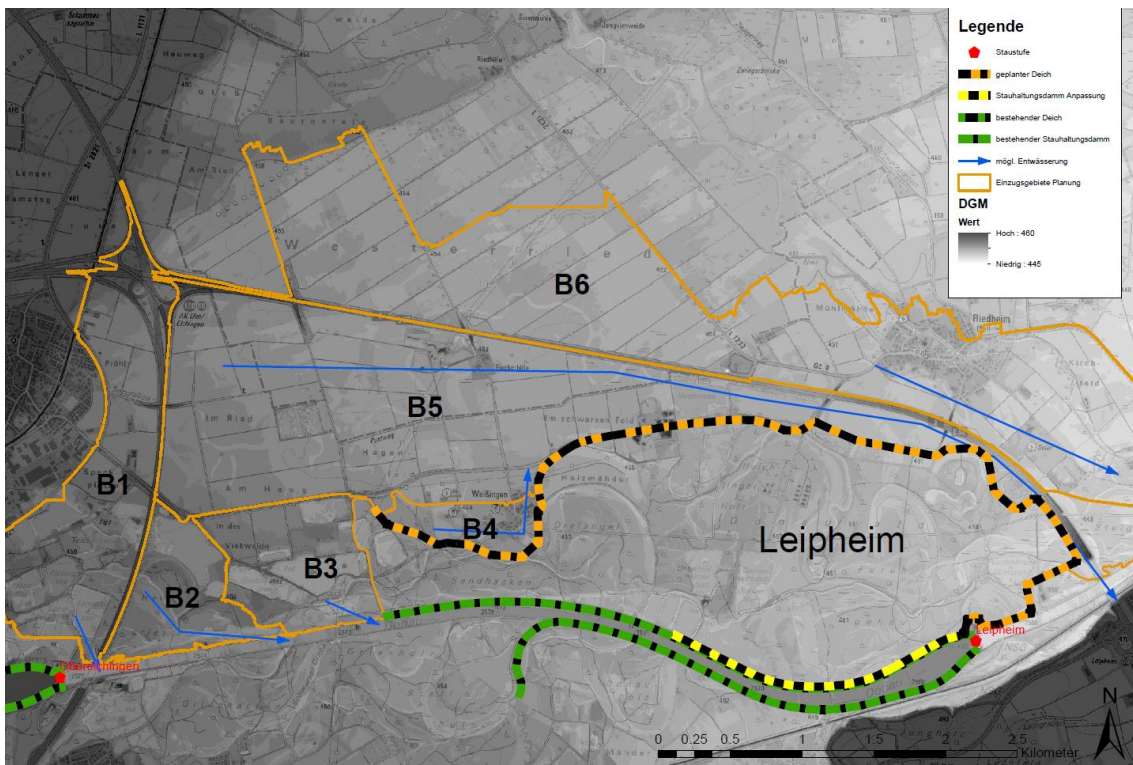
Lageplan Rückhalteraum Leipheim, ROVar A
